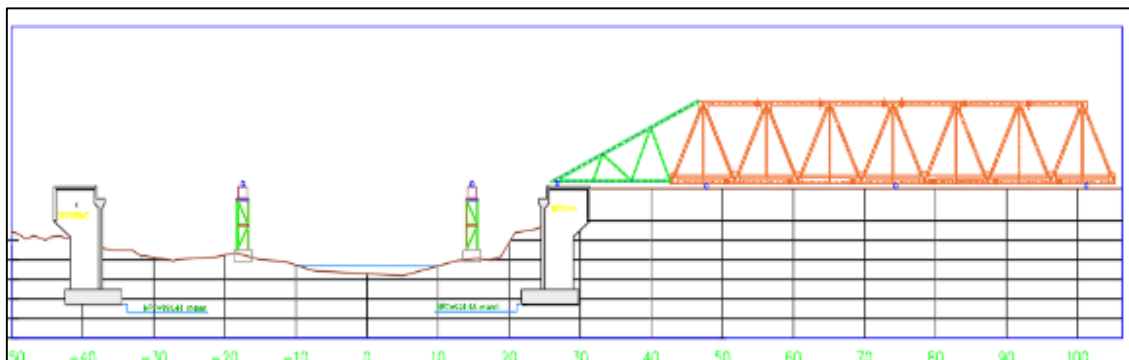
Etapa inicial del plan del plan de lanzamiento.
